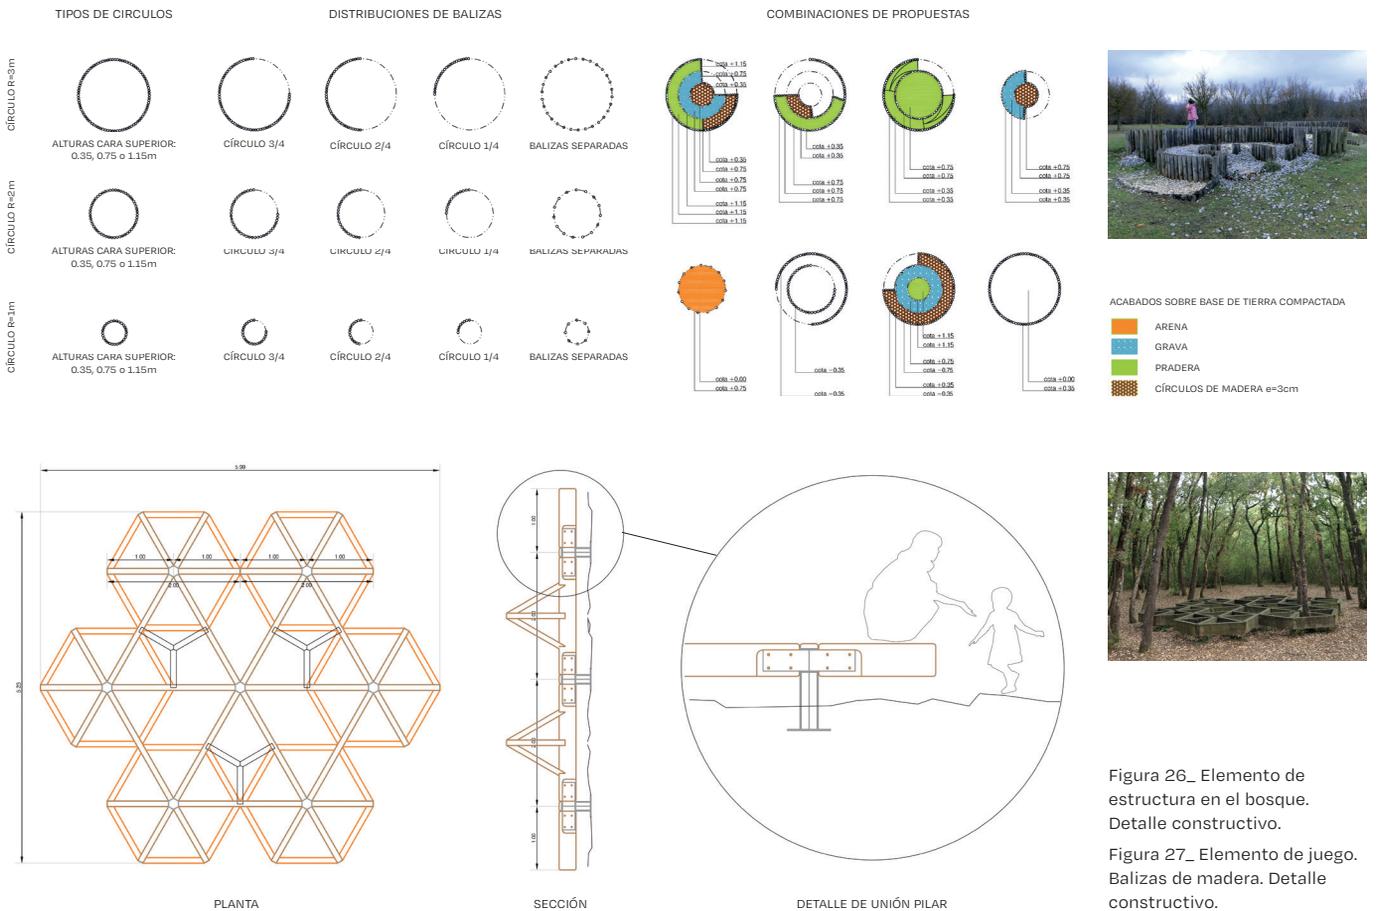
Elemento de estructura en el bosque. Detalle constructivo.
